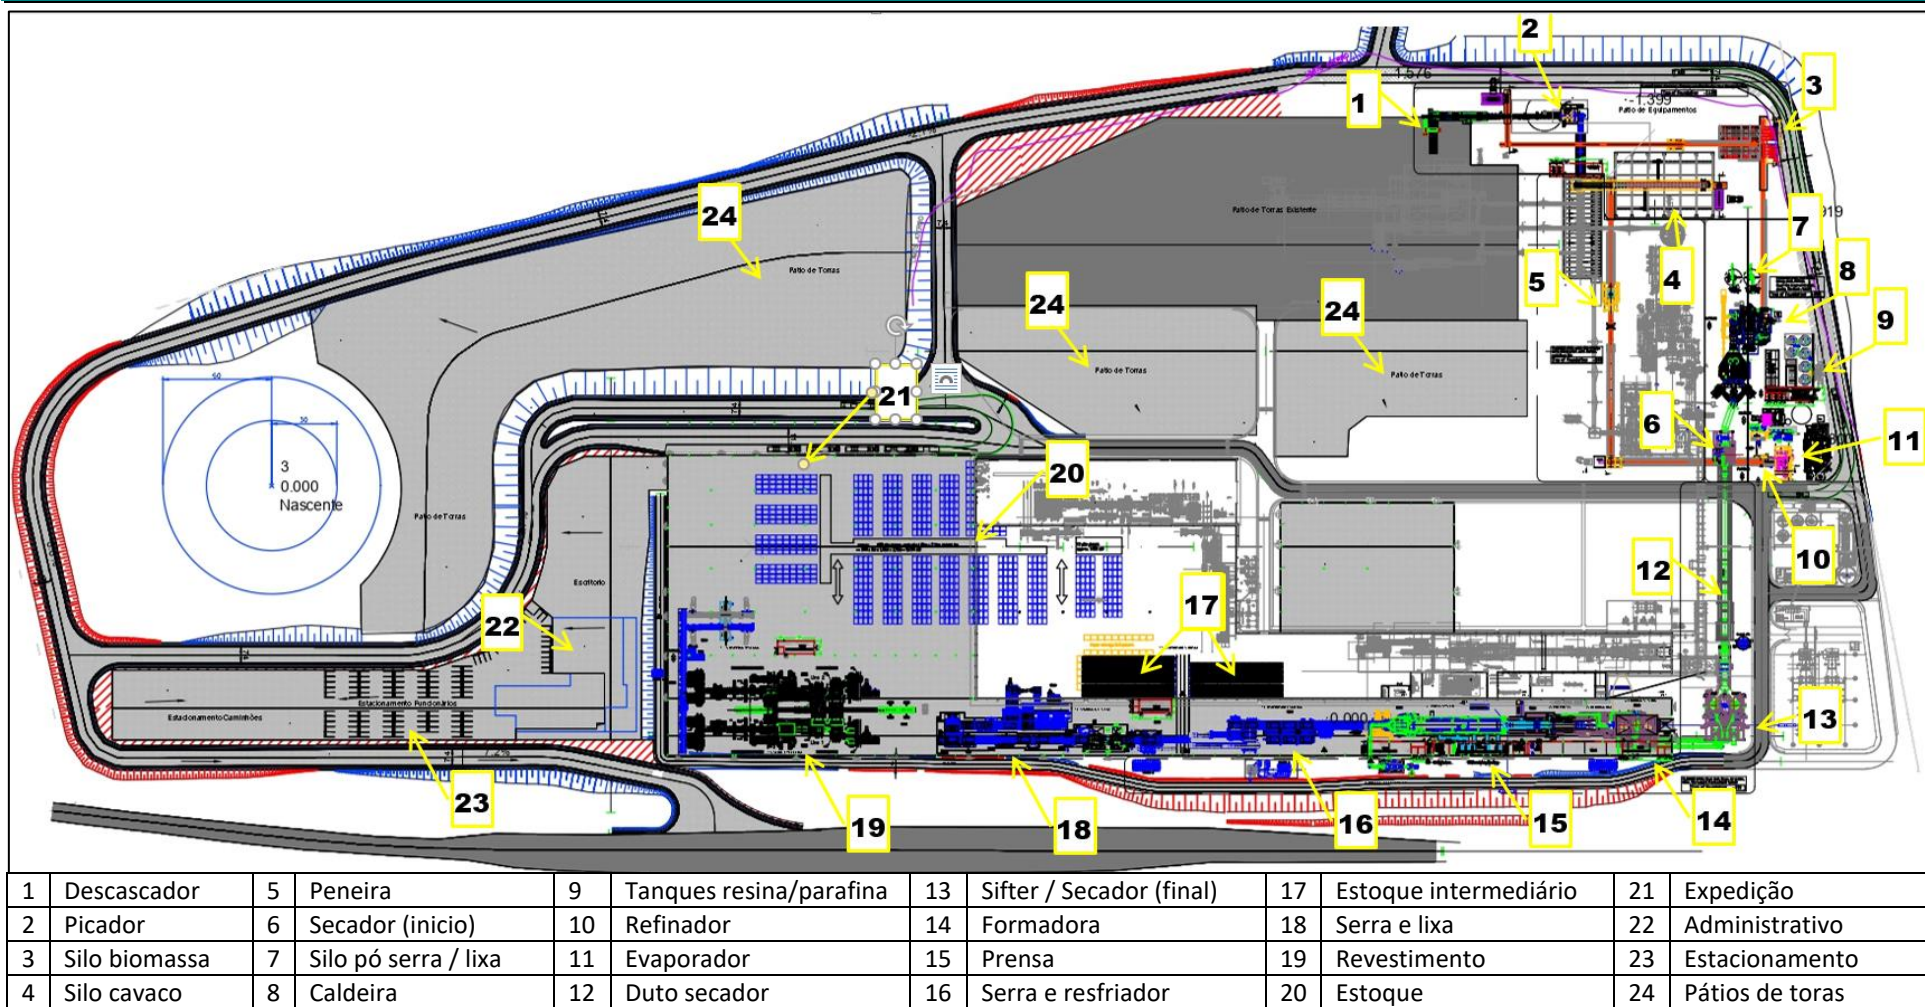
Demonstração das estruturas previstas para ampliação do empreendimento.
